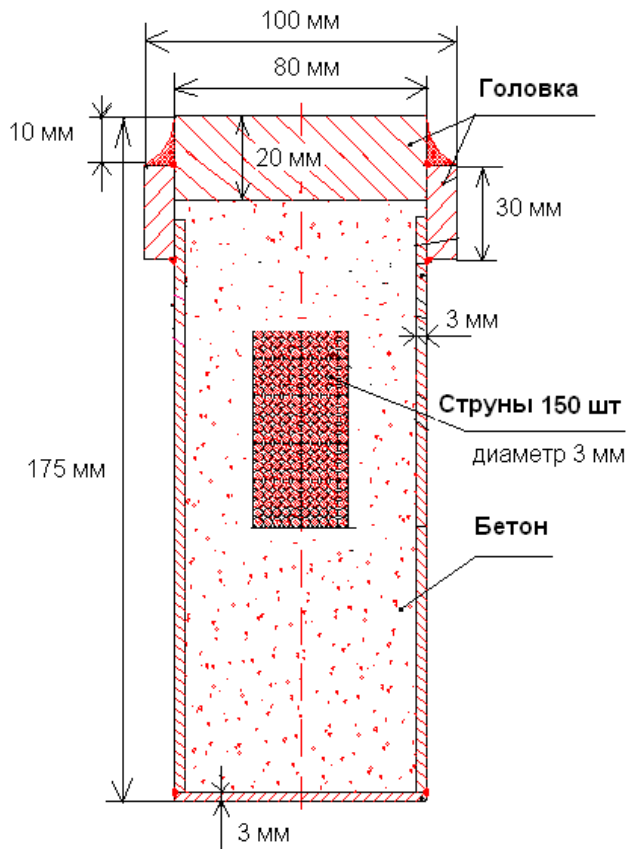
Расчетное поперечное сечение рельса-струны
